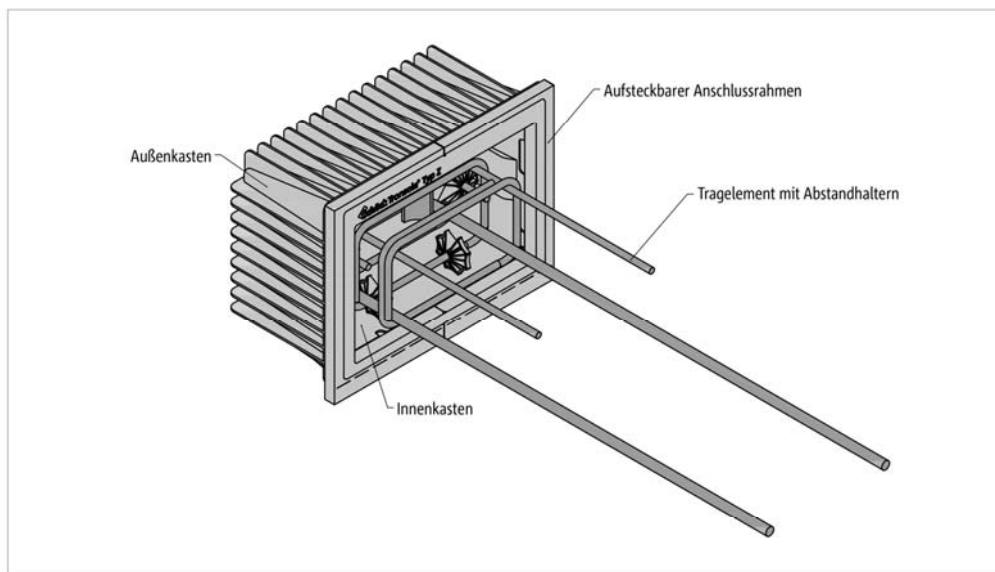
Schöck Tronsole® Typ Z: Wandelement, bestehend aus Außenkasten, Innenkasten, Anschlussrahmen und integrierten Elastomerlagern Elodur®, die im Bild nicht sichtbar sind. Das Tragelement ist optional erhältlich und wird in das Treppenpodest einbetoniert.
